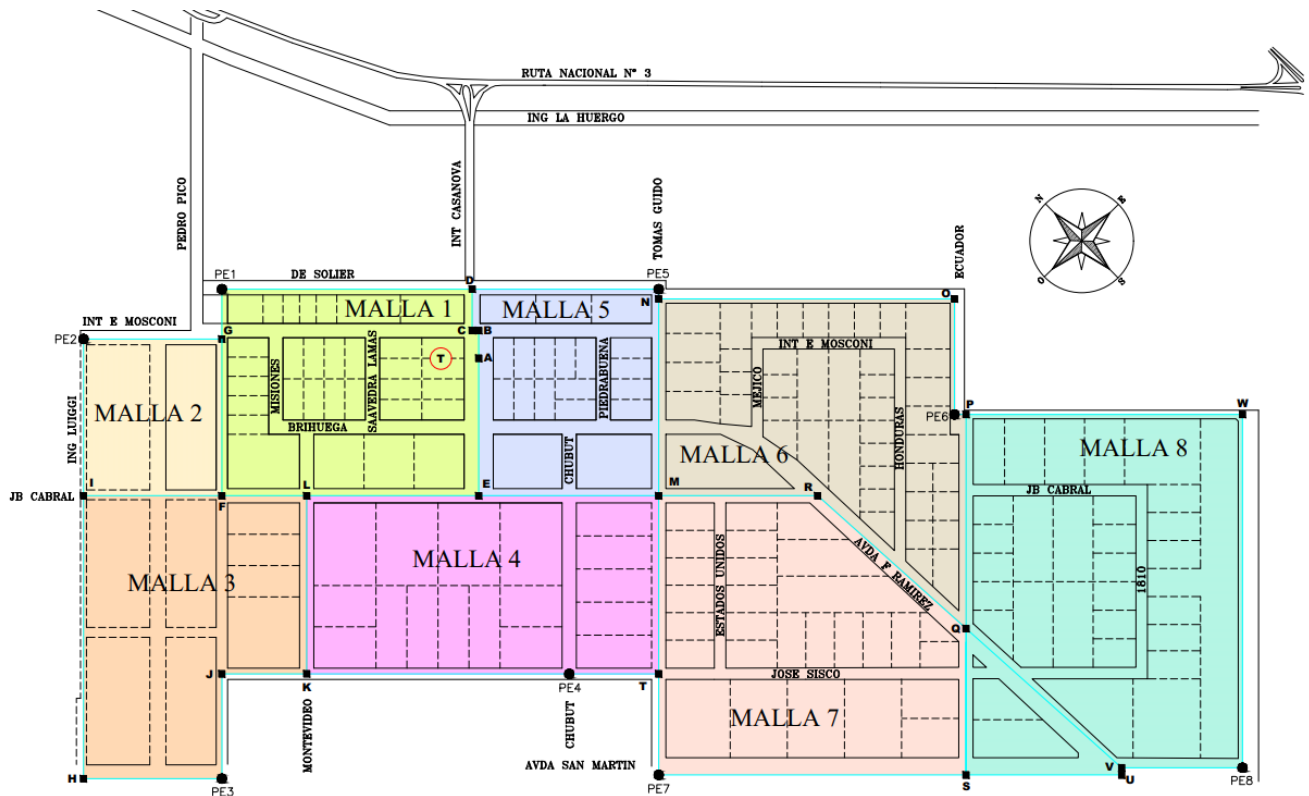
Disposición de mallas. Plano A. Fuente: Elaboración propia.
